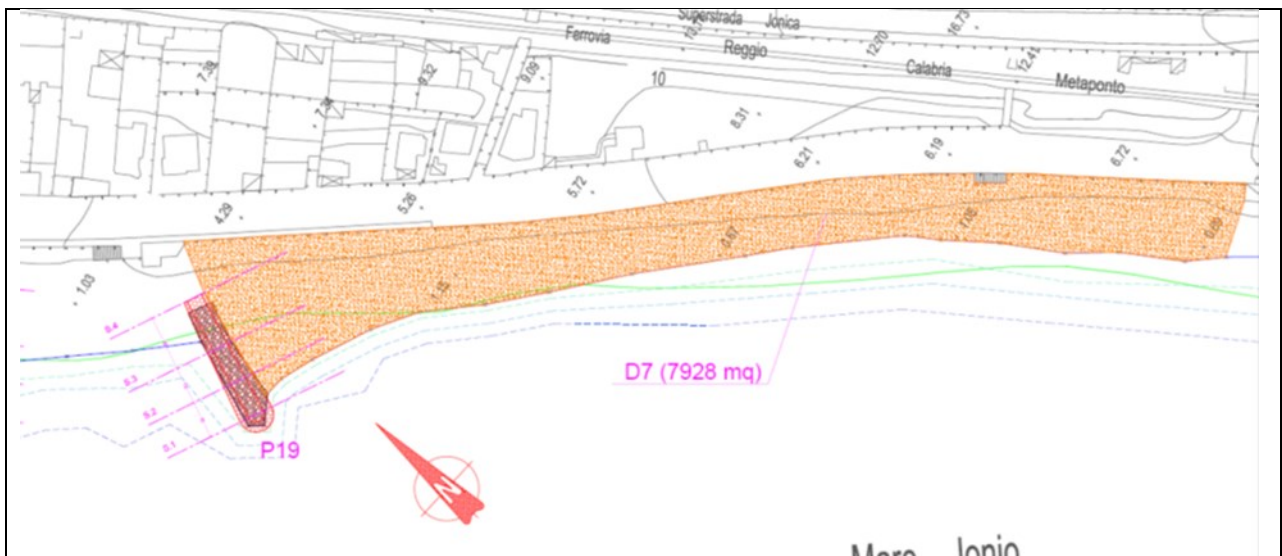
Schema planimetrico intervento Lazzaro area A lungomare Cicerone tratto finale lato Capo d'Armi
